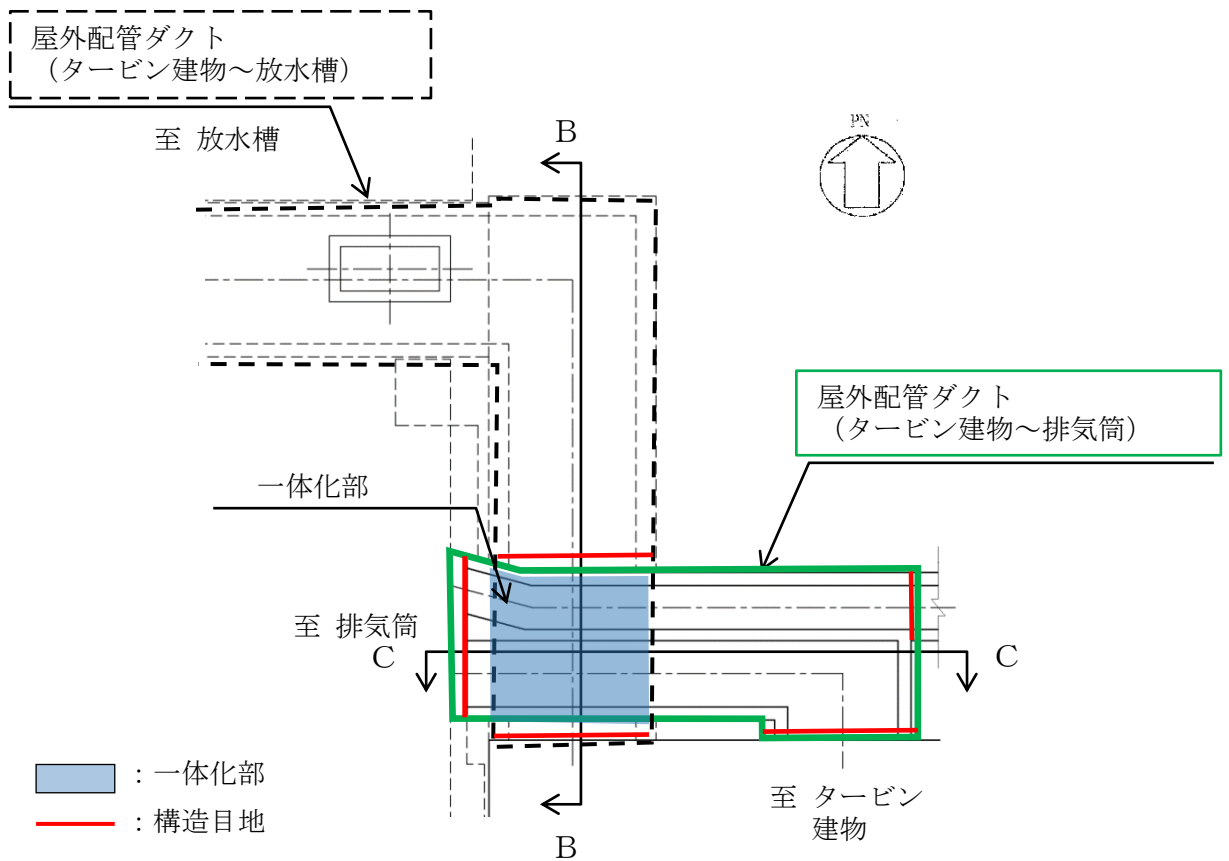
屋外配管ダクト（タービン建物～排気筒） 平面図
